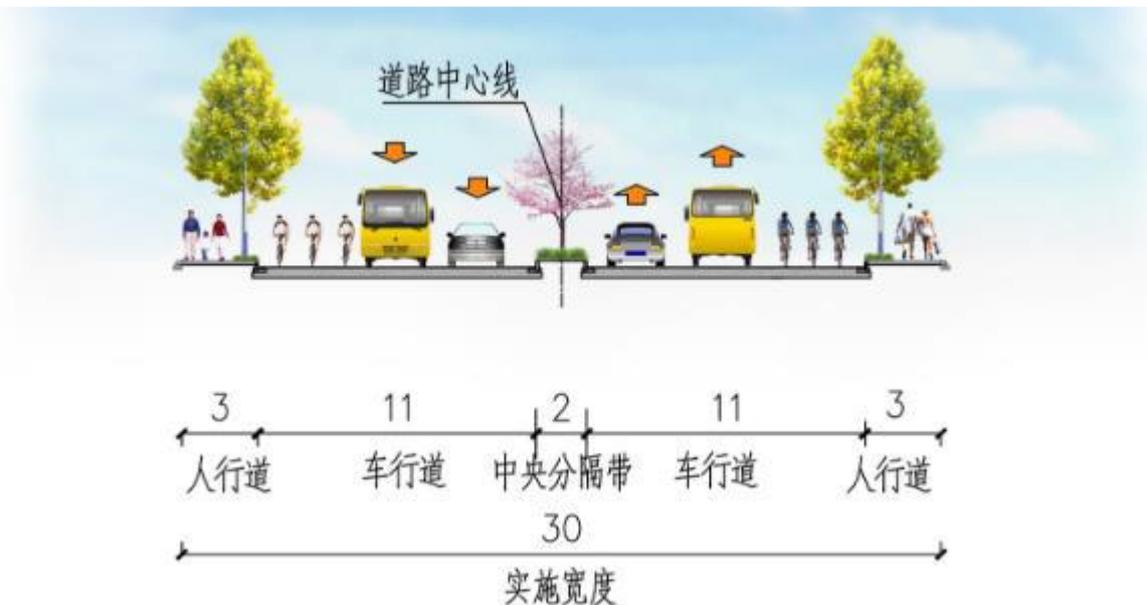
(a) 泰融路（姜高路-沪渝蓉铁路段）横断面布置图
